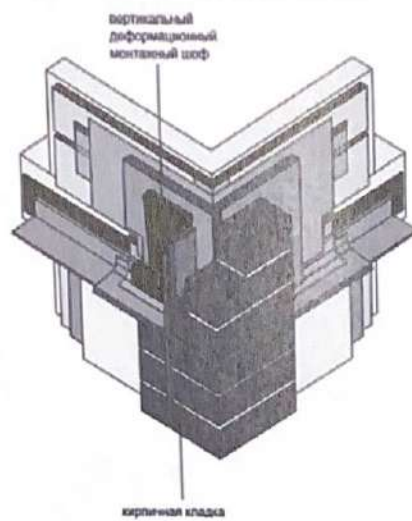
Техническое решение конструкции трехслойной стены на внешнем углу [1.24]
